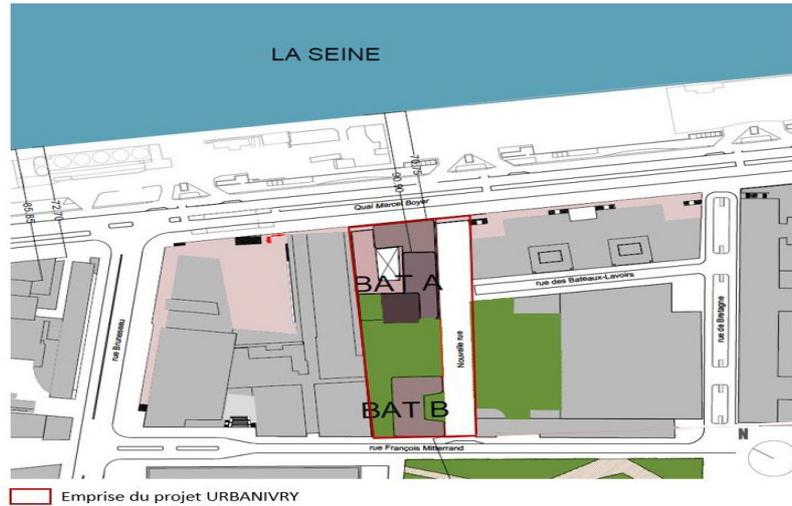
Emprises du projet URBANIVRY (Fond de plan : ARCHIKUBIK)
